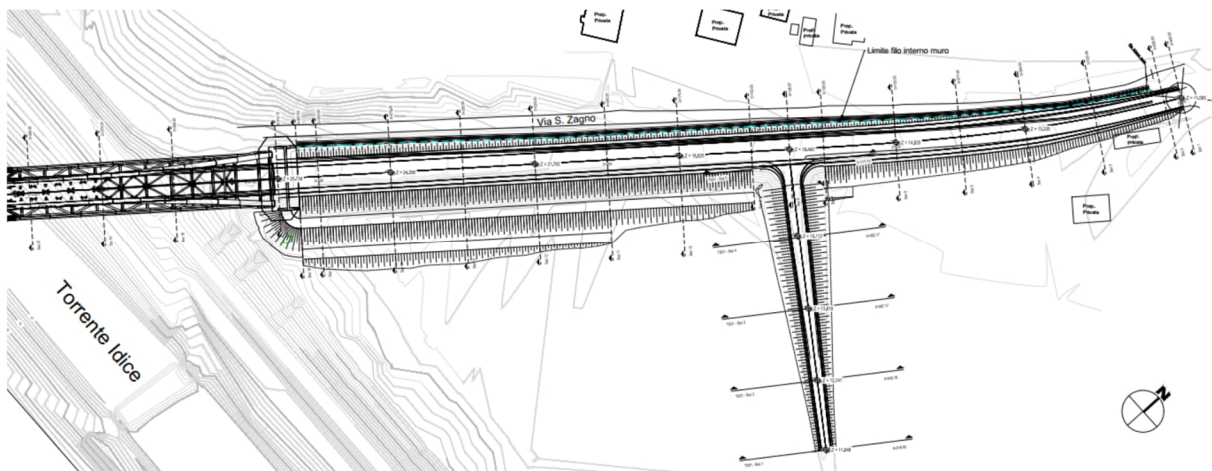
Planimetria del tracciato principale lato sponda sinistra idraulica
